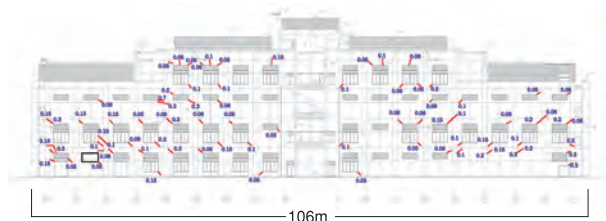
施工中の外壁に生じたひび割れの例³⁾
